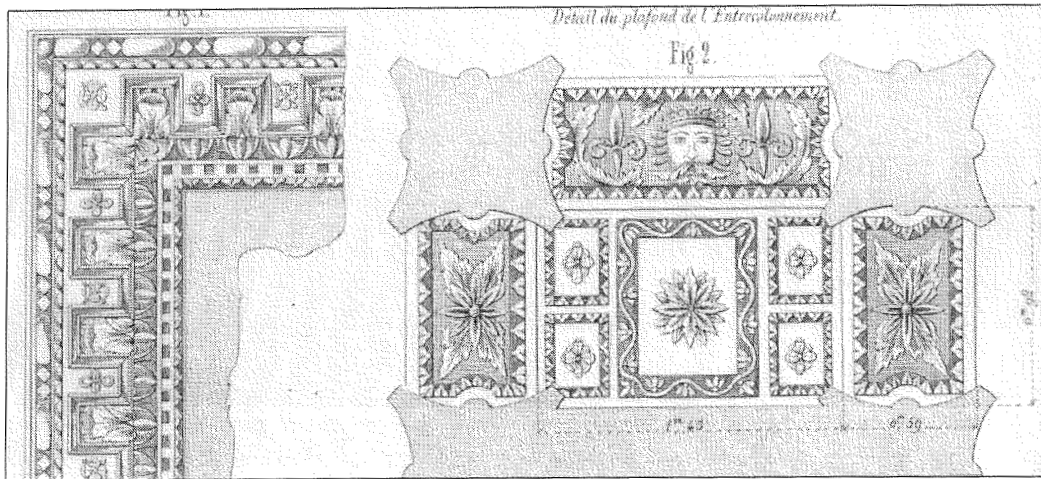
A gauche, « détail du plafond de la corniche, vue en dessous » ; à droite, détail du plafond de l'entrecolonnement, in Moll.
